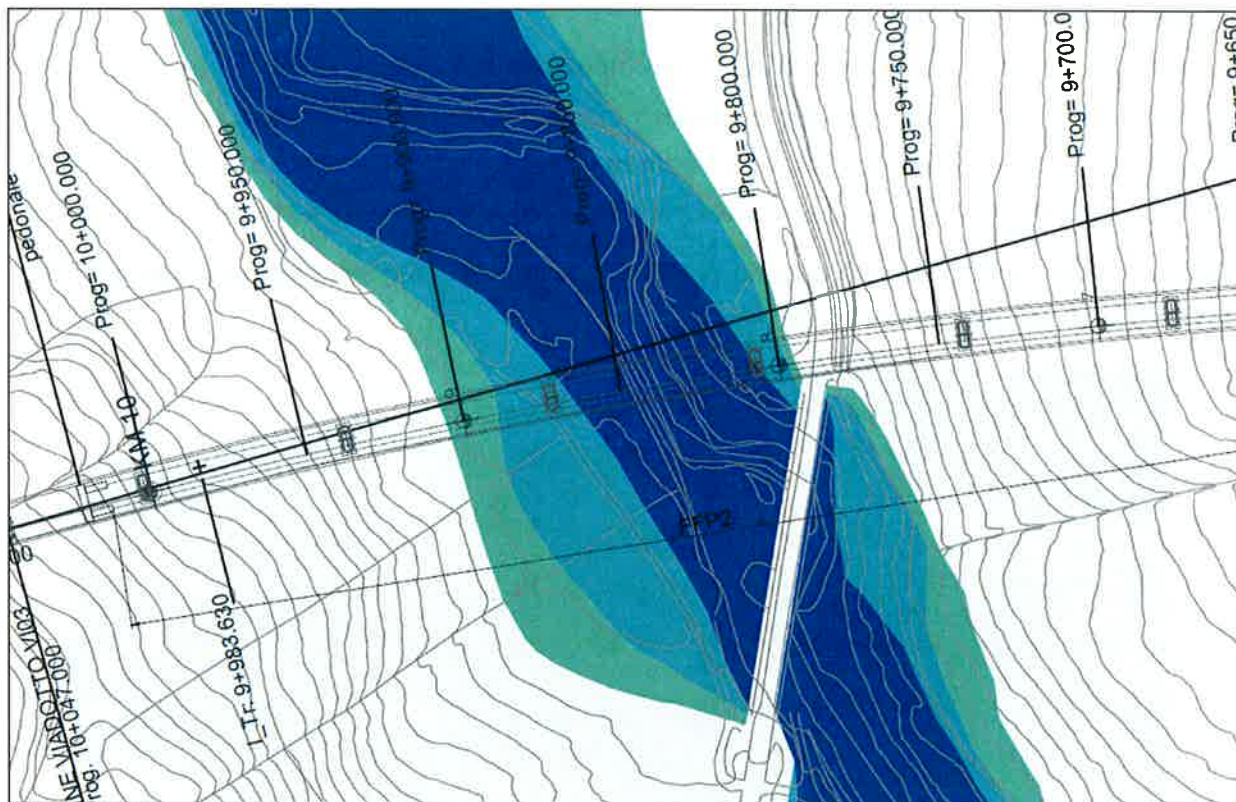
Stralcio planimetrico del PAI vigente in corrispondenza del viadotto VI03 di progetto
